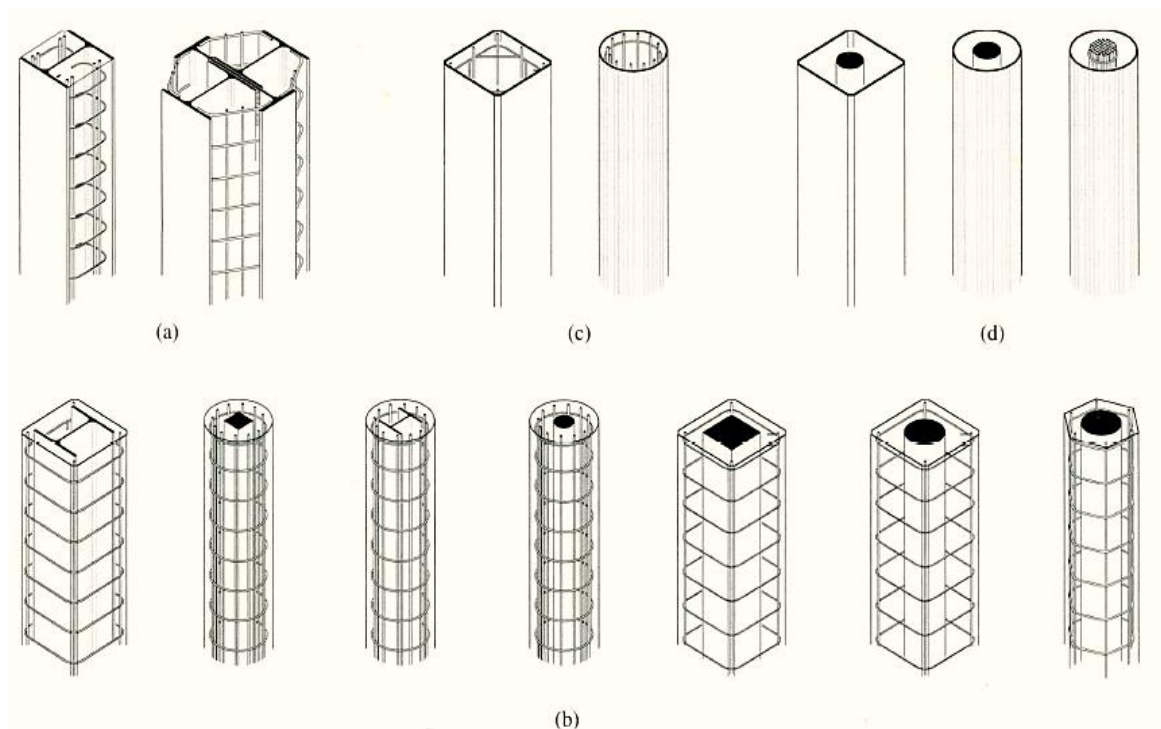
Types de poteaux mixtes acier-béton [26].
